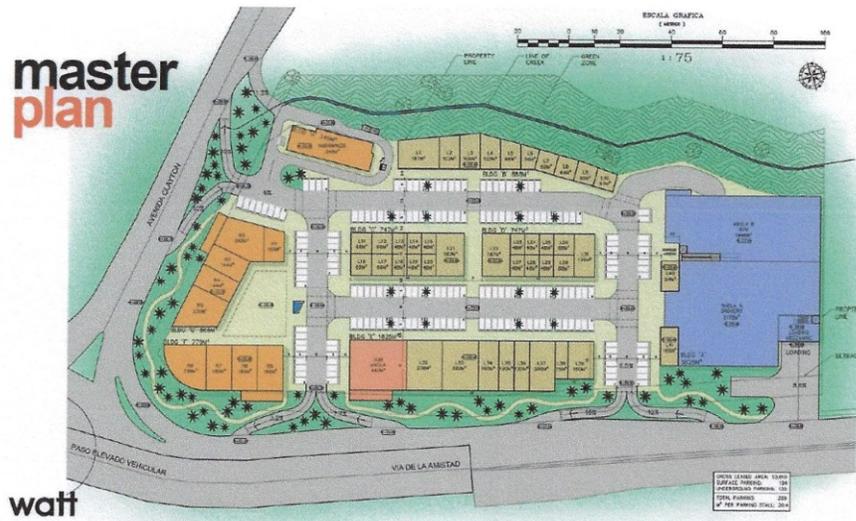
Plan Maestro Clayton Station. Fuente: Equipo diseñador
